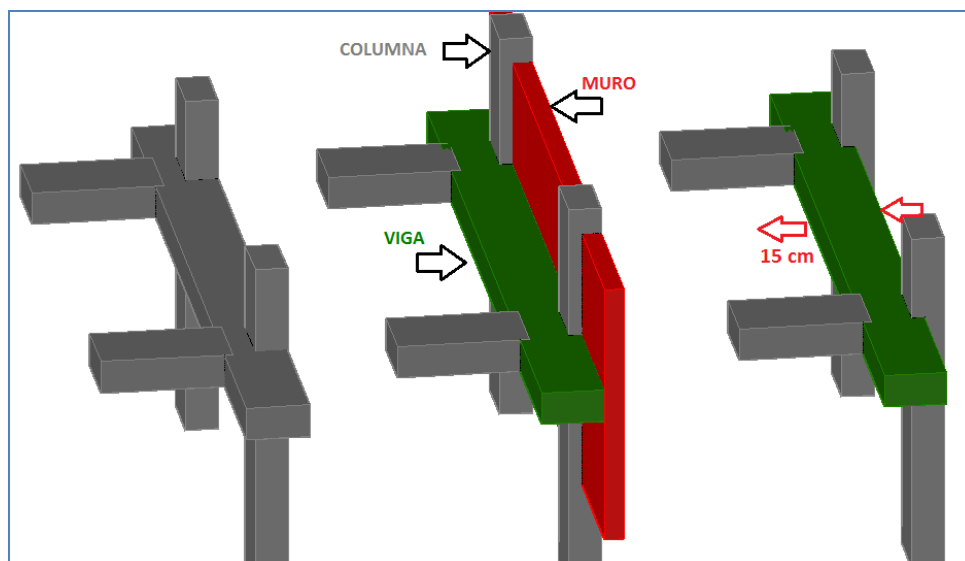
Esquema de la modificación en la posición de las vigas medianeras por errores de proyecto.
